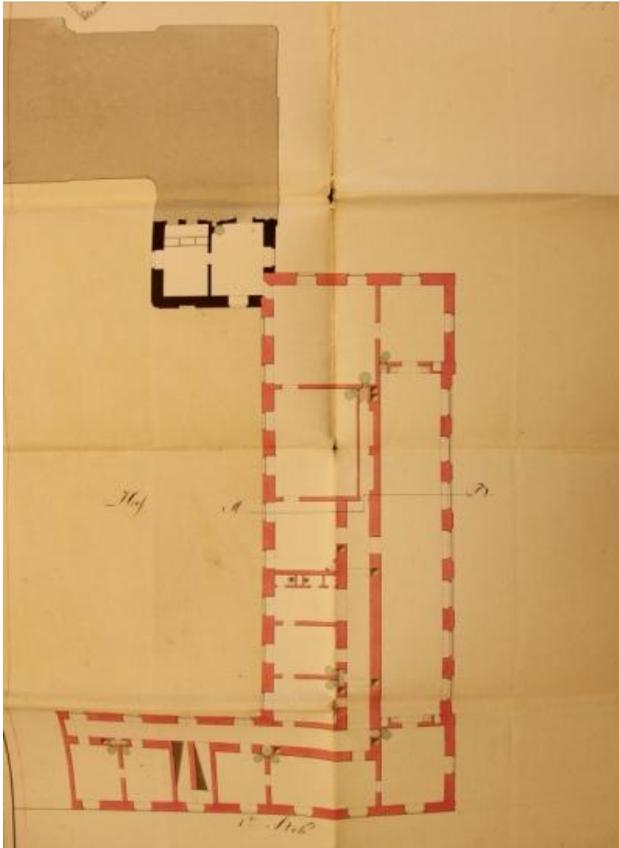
Franz Wipplinger, Einreichplan / Gartenpalais Modena: Grundriss 1. OG rechter Seitenflügel, 1803, WStLA, Wien.
